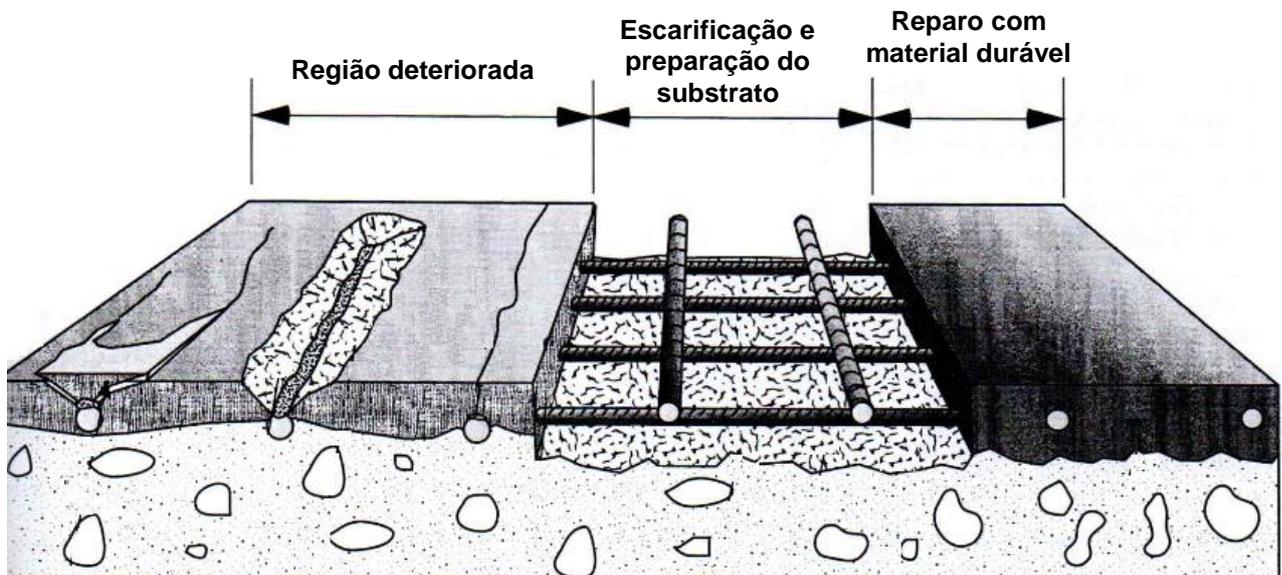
Seqüência esquemática de realização de reparo em concreto estrutural (adaptado de P.H. EMMONS, 2001)
